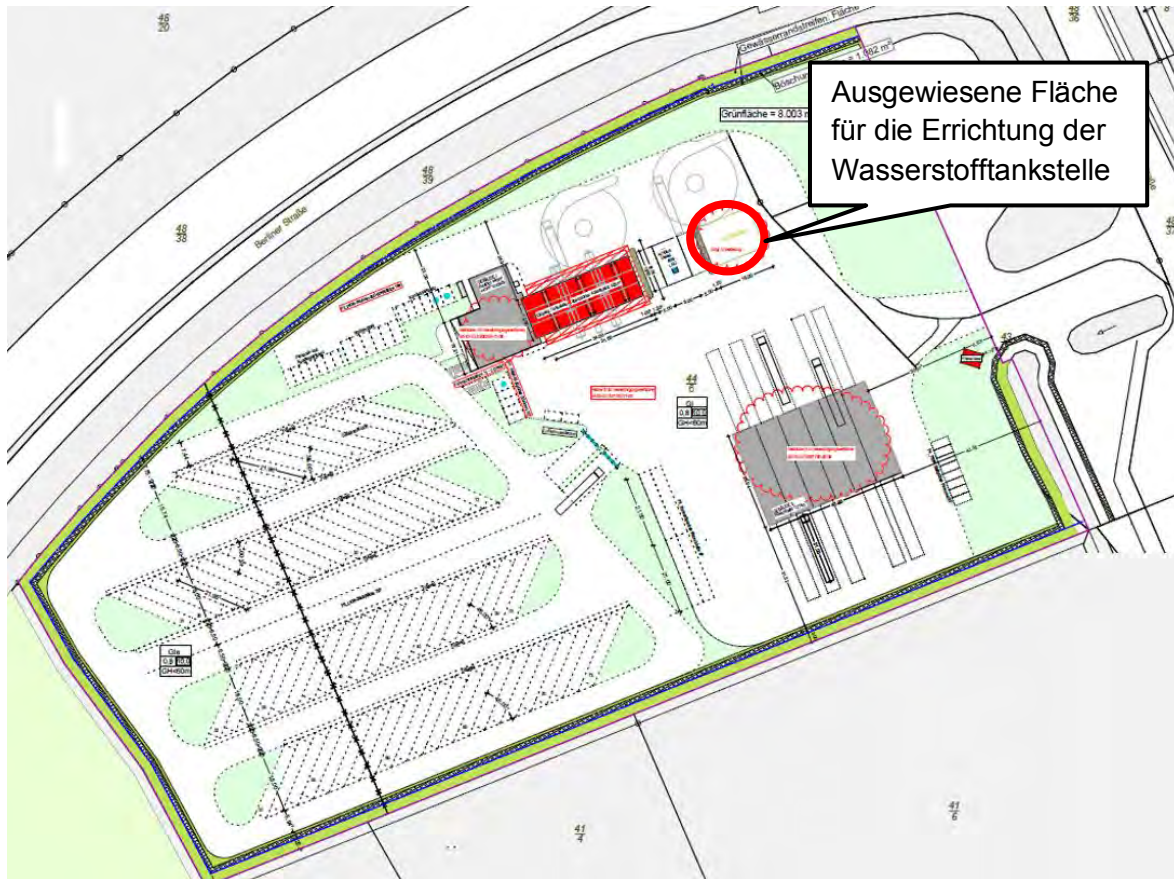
Lageplan der geplanten Tank- und Rastanlage im Braker Hafen gemäß Bauantrag der Truckpoint Braker Hafen GmbH vom 11.10.2021
